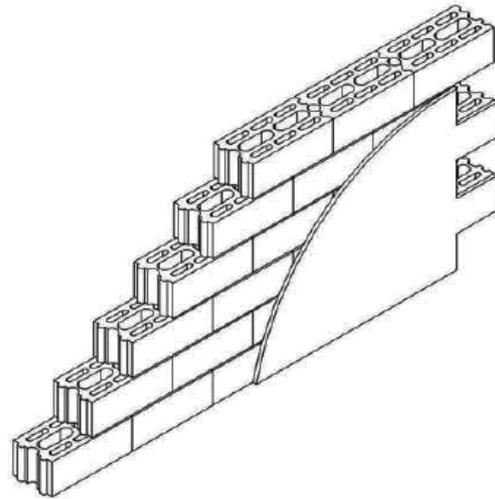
Muro enfoscado de árido ligero multicámara.
